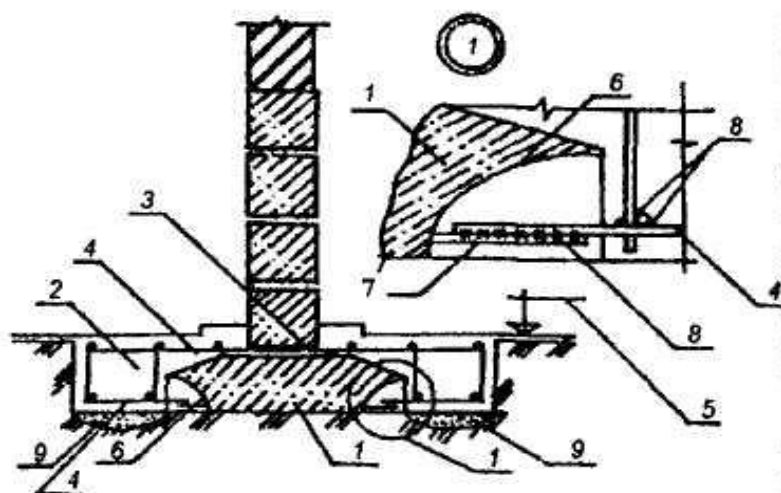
Уширение подошвы для ленточного сборного фундамента (устройство железобетонной обоймы)
